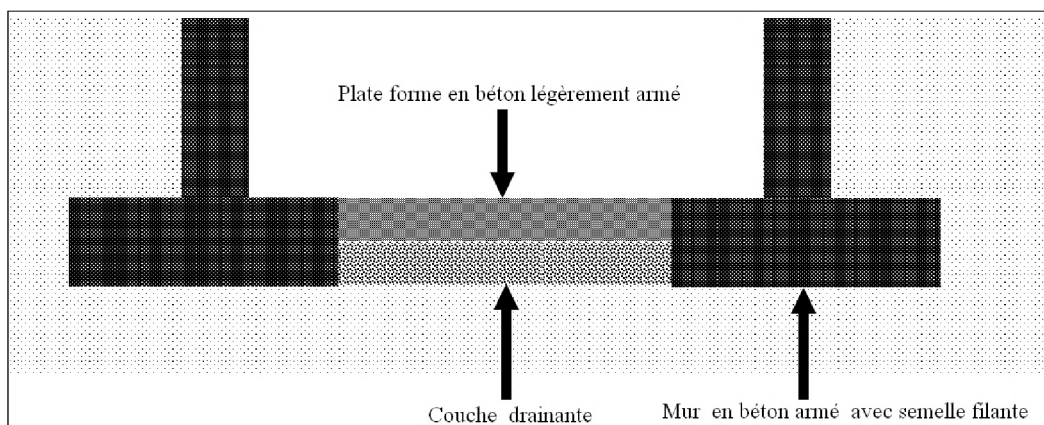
Coupe transversale d'un canal en béton armé de section rectangulaire
